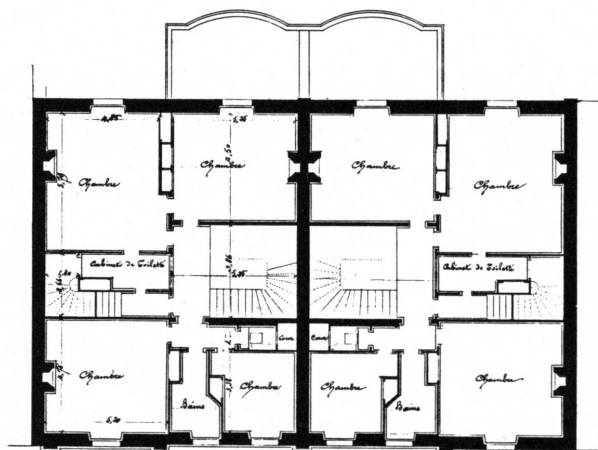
Rue Bellot nos 10 et 12. Plan du 1<sup>er</sup> étage.
